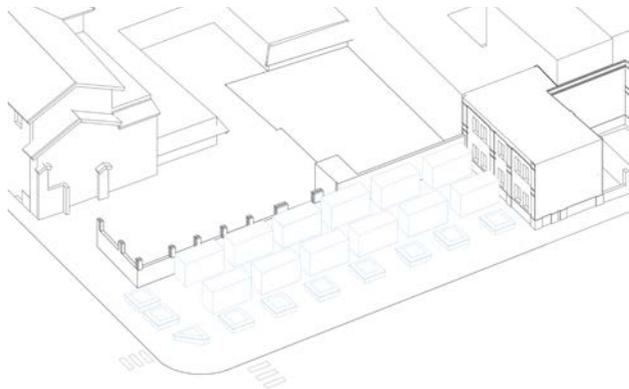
Elementos existentes en la plaza Fuente: Autoría propia.
